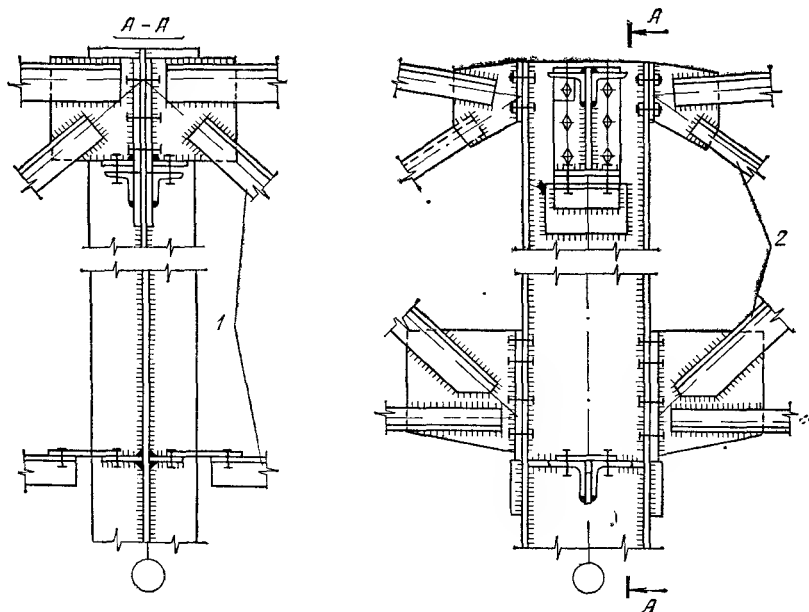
Узел опирания подстропильной фермы на колонну
